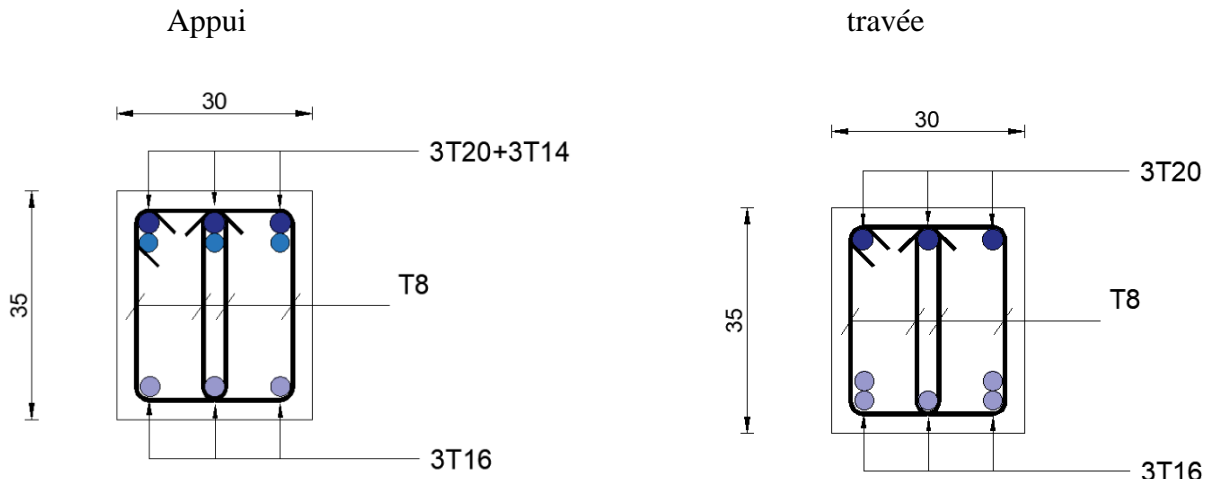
schéma de ferrailages des poutres porteuse (8^{ème} étage---RDC)
